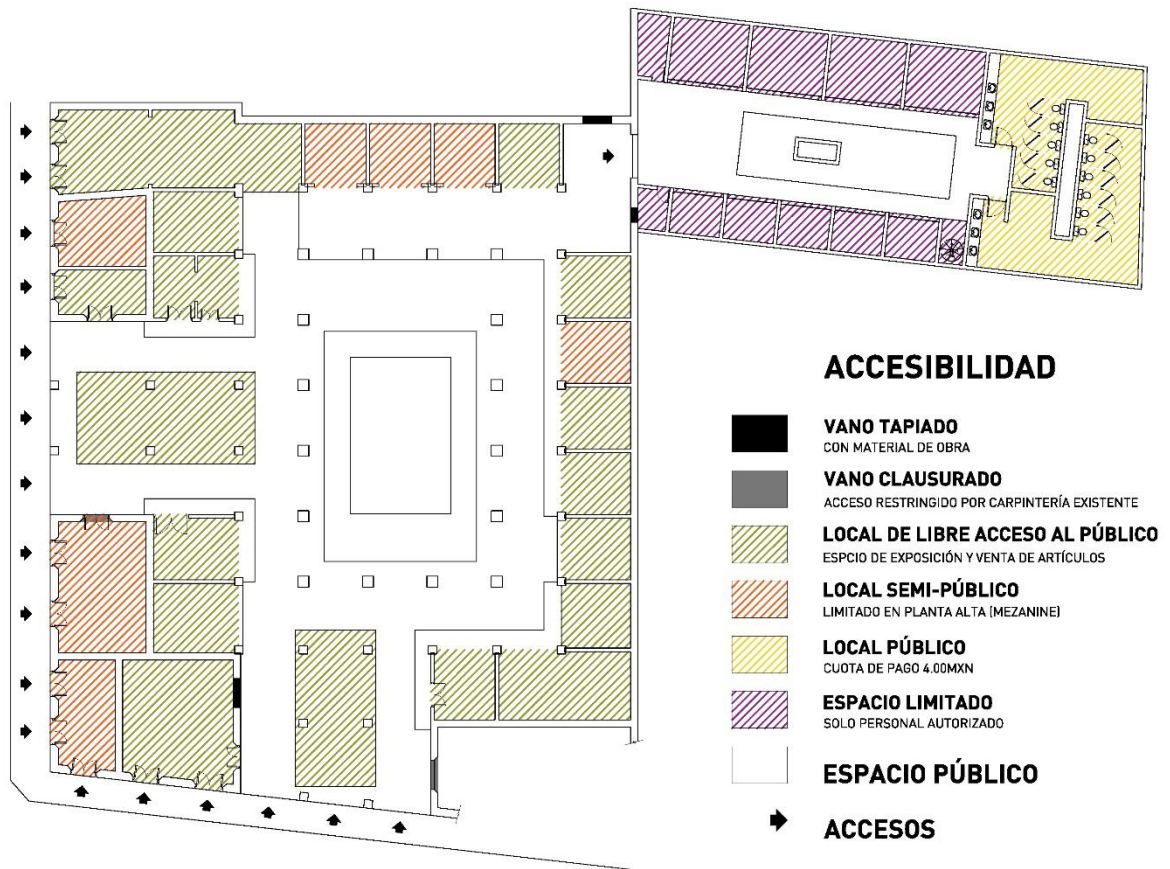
Plano de accesibilidad del Mercado de Artesanías en su estado actual.
